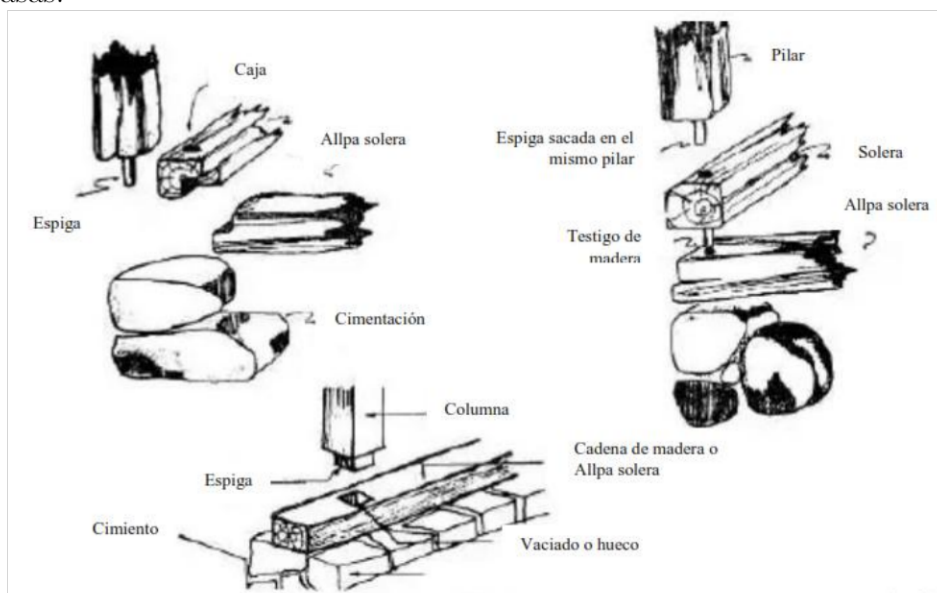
Ensamblajes para una vivienda de bahareque. Tomada de [https://www.academia.edu/29898709/Análisis de la arquitectura vernal del Ecuador Propuestas de una arquitectura contemporánea sustentable\\_email\\_work\\_card=title](https://www.academia.edu/29898709/Análisis_de_la_arquitectura_vernal_del_Ecuador_Propuestas_de_una_arquitectura_contemporánea_sustentable_email_work_card=title)
